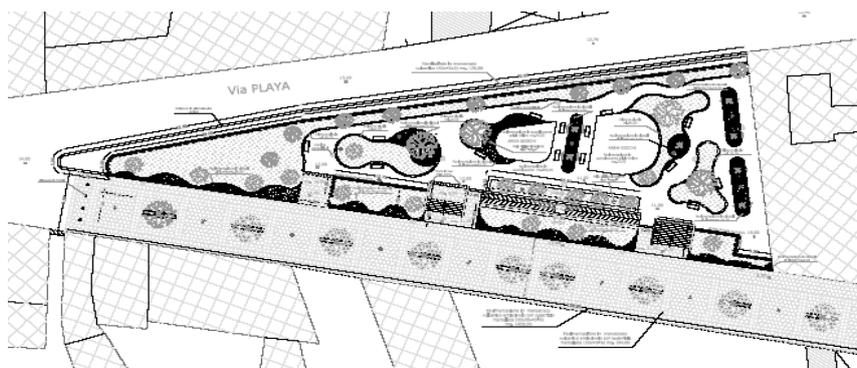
Planimetria del progetto di sistemazione ad area a verde in via delle Ondine (Comune di Catania)
